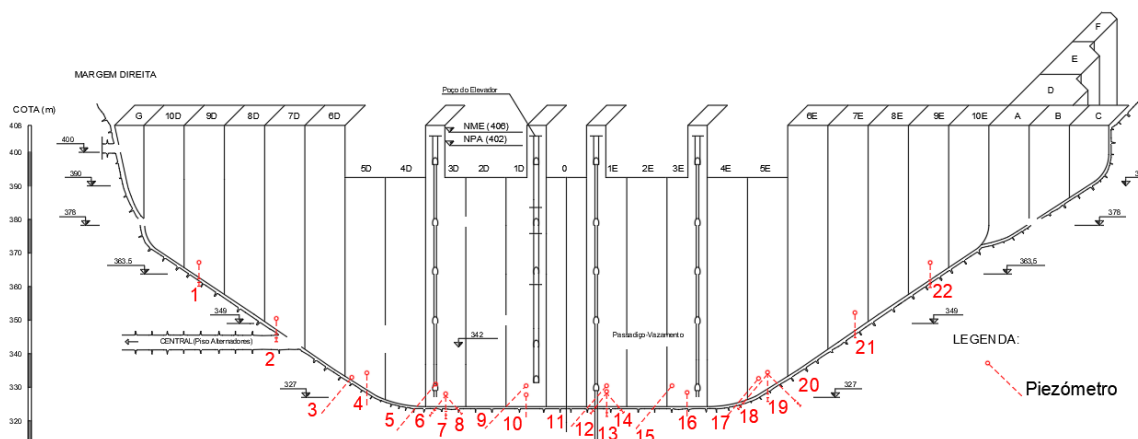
Localização dos piezómetros da barragem da Bemposta (adaptado de LNEC, 2020).
